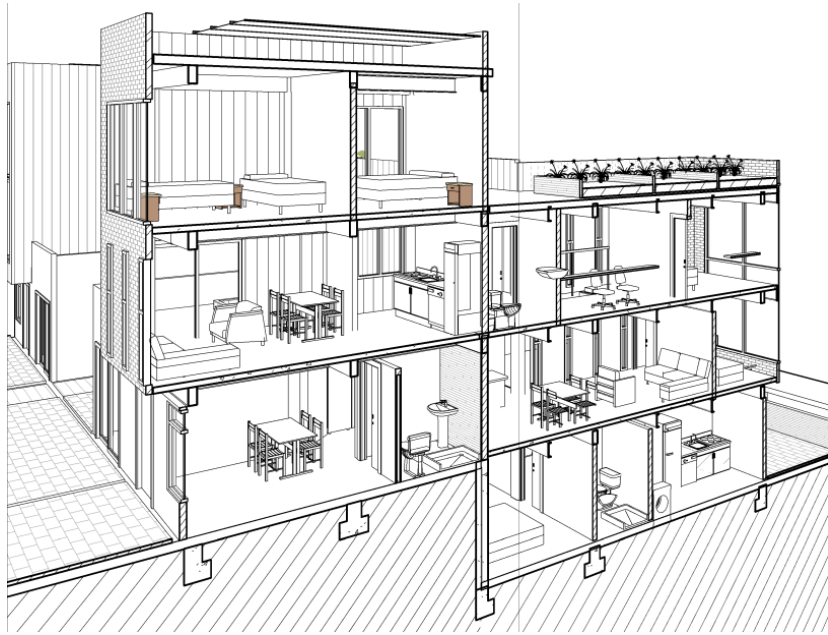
Corte Axonometrico 1 sistema constructivo. Fuente: Propia
